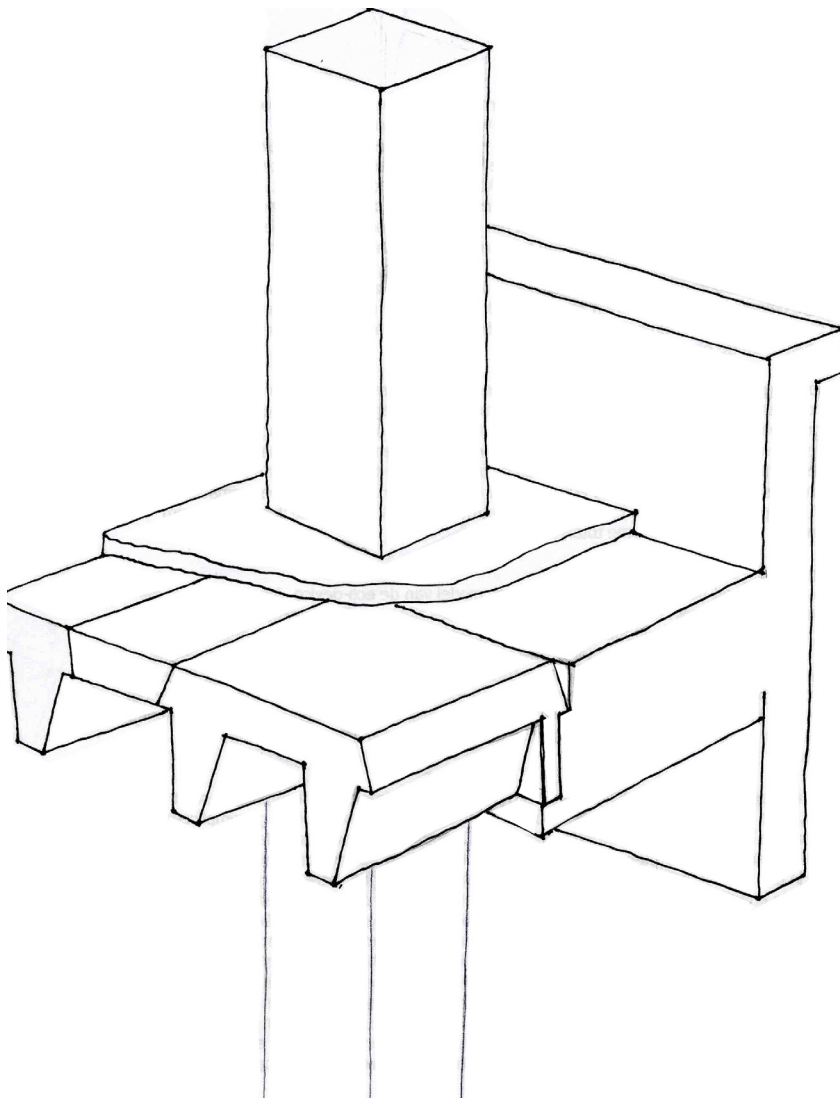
Samenkomst van de draagconstructie van de laagbouw en van de hoogbouw (bron: Fotografische Dienst TU Delft faculteit Bouwkunde)
